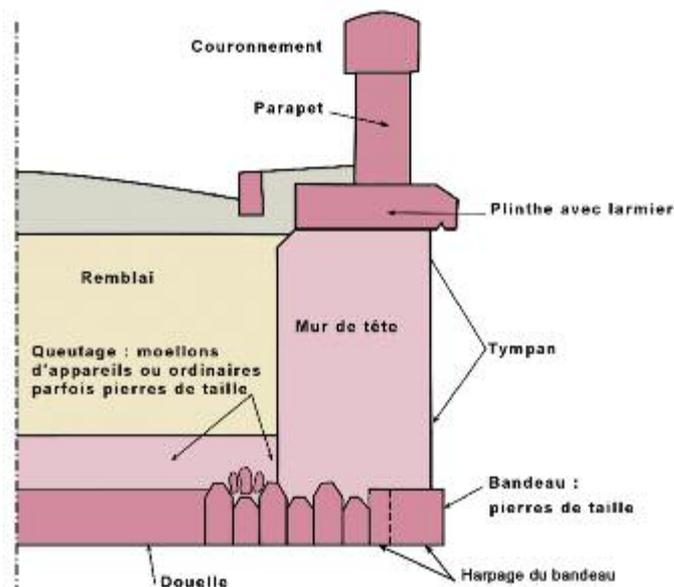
demi-coupe transversale schématique d'un pont en maçonnerie
